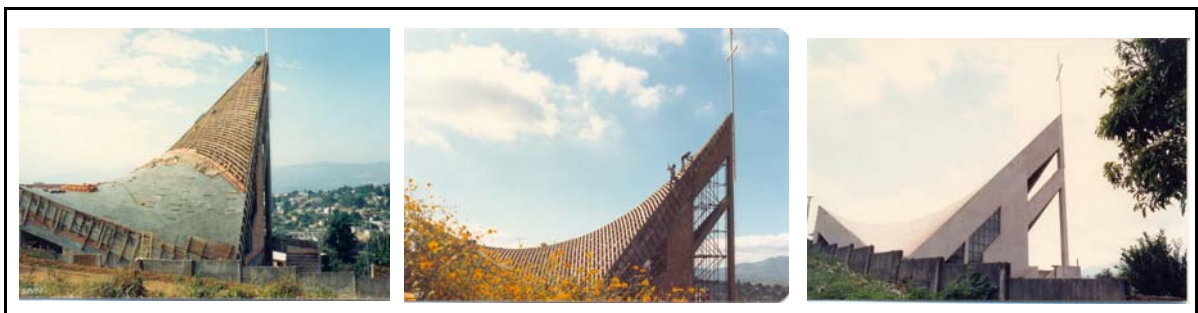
Igreja do Bairro Lindéia – sistemas construtivos – eng. Roberto Fontes.
